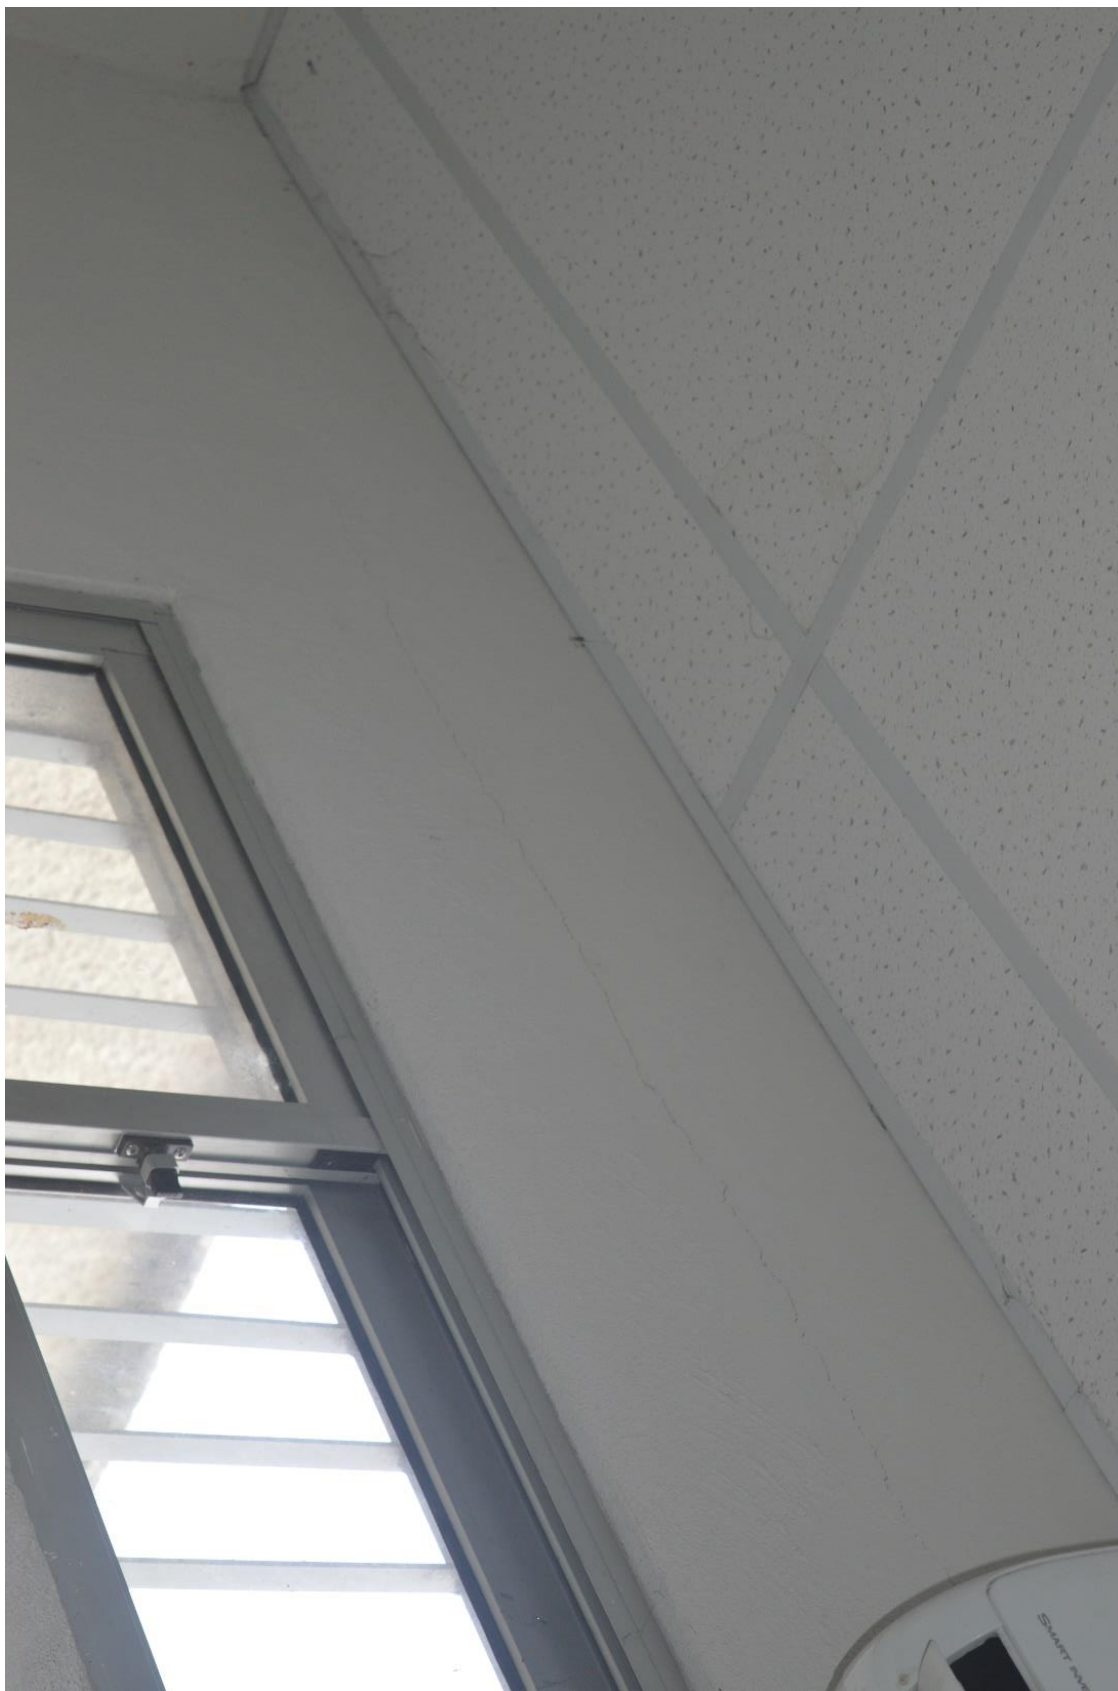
Depósito Anexo - Fissura horizontal acima do vão das básculas
